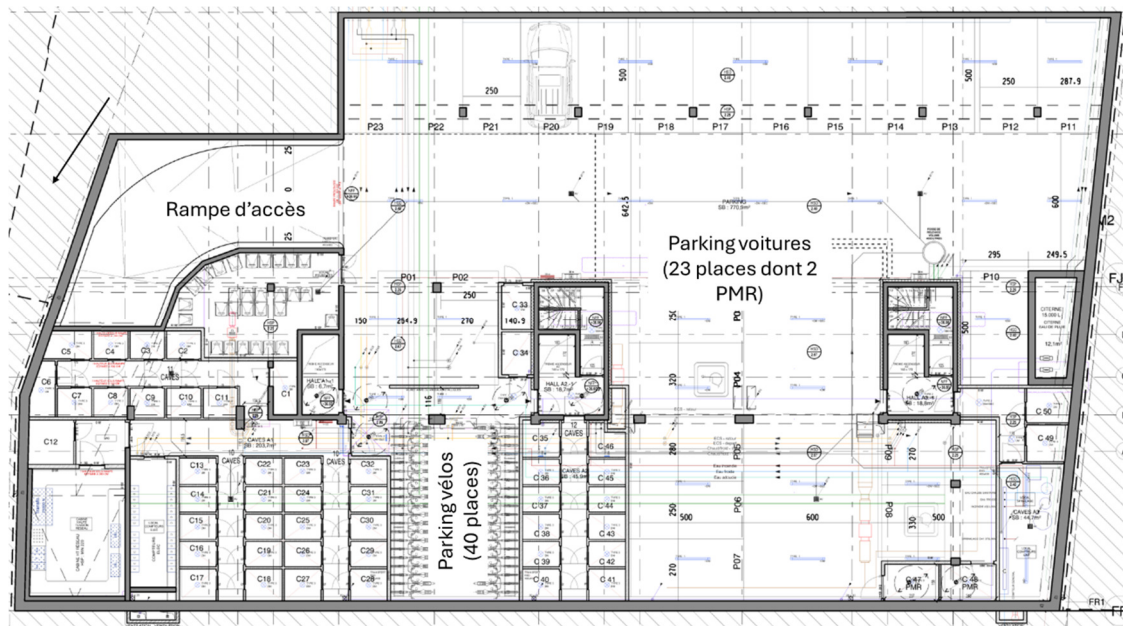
Parking bâtiment A étage -1 (Source: ).
